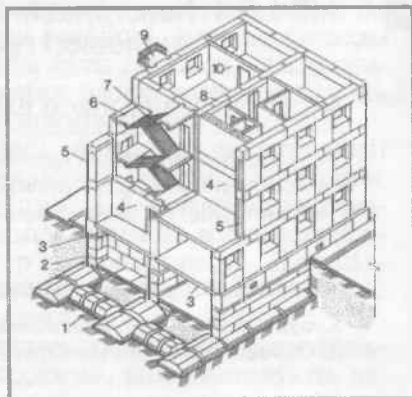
Великопанельні будівлі з поздовжніми несучими стінами:
